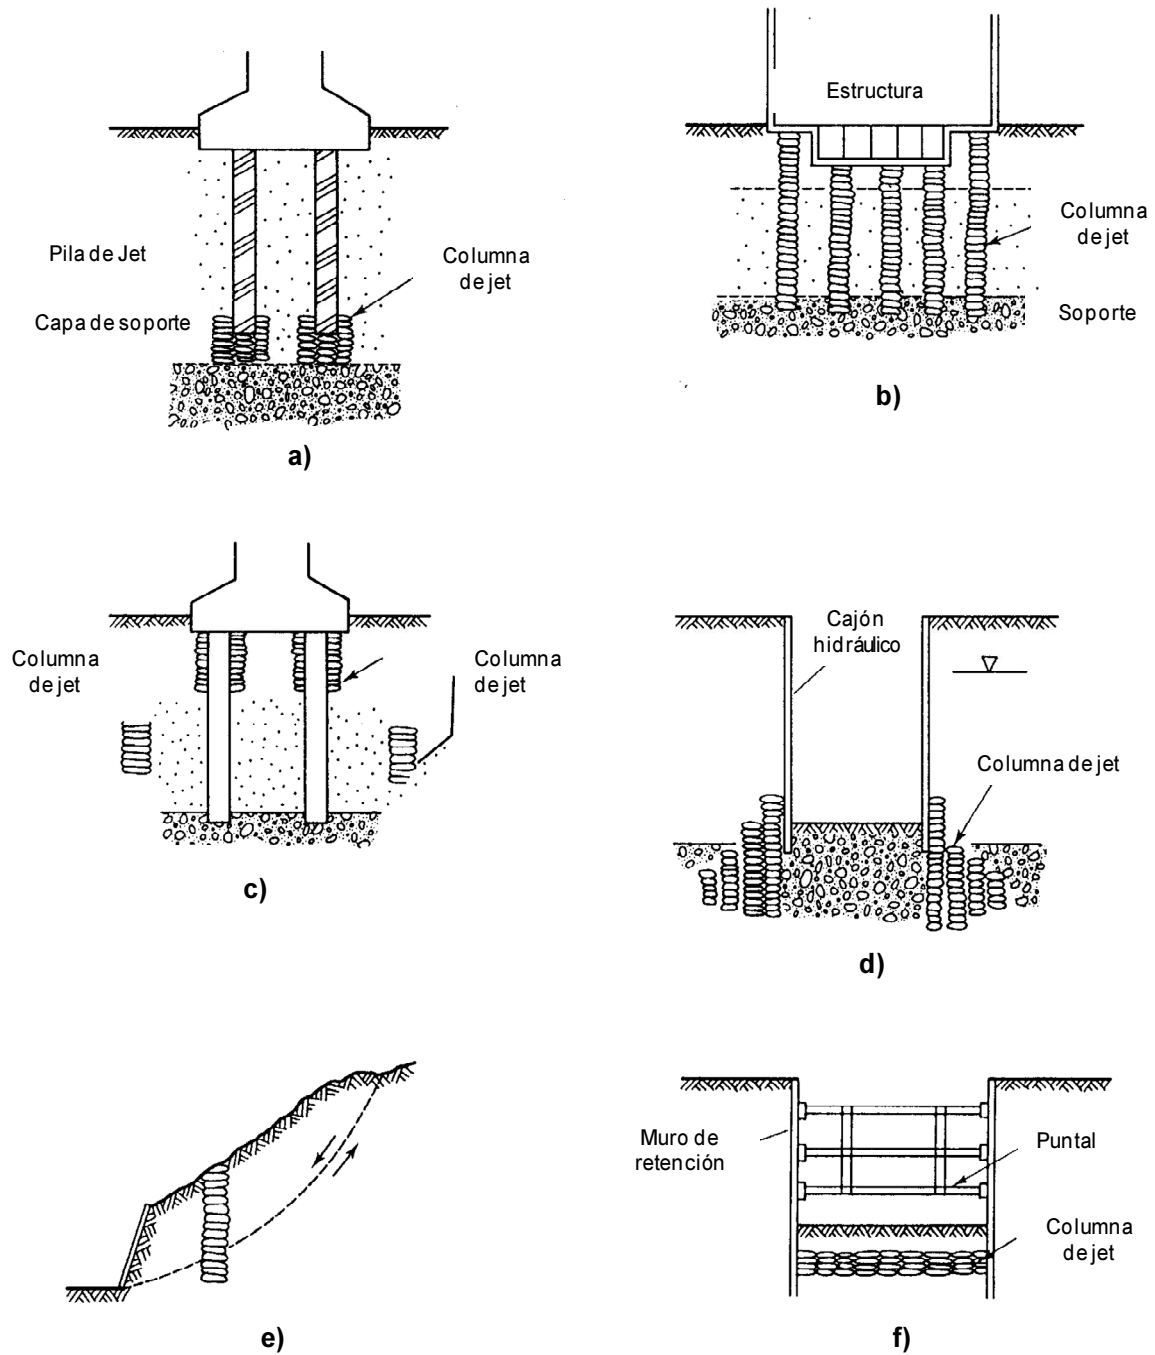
Aplicaciones del Jet Grouting (Hsai-Yang Fang, 1991).
